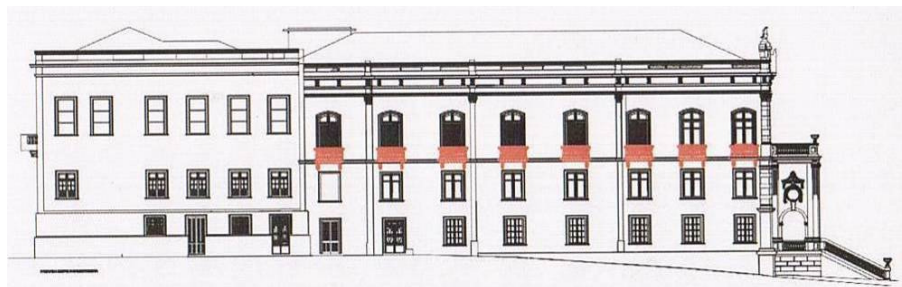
Fachada Oeste/Sudoeste. Destaque para os novos balcões desta fachada
